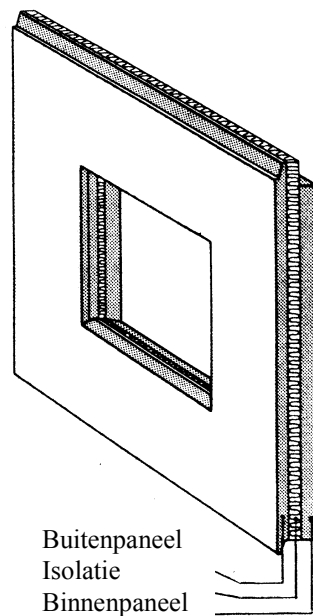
Principe van een sandwichelement in architectonisch beton
